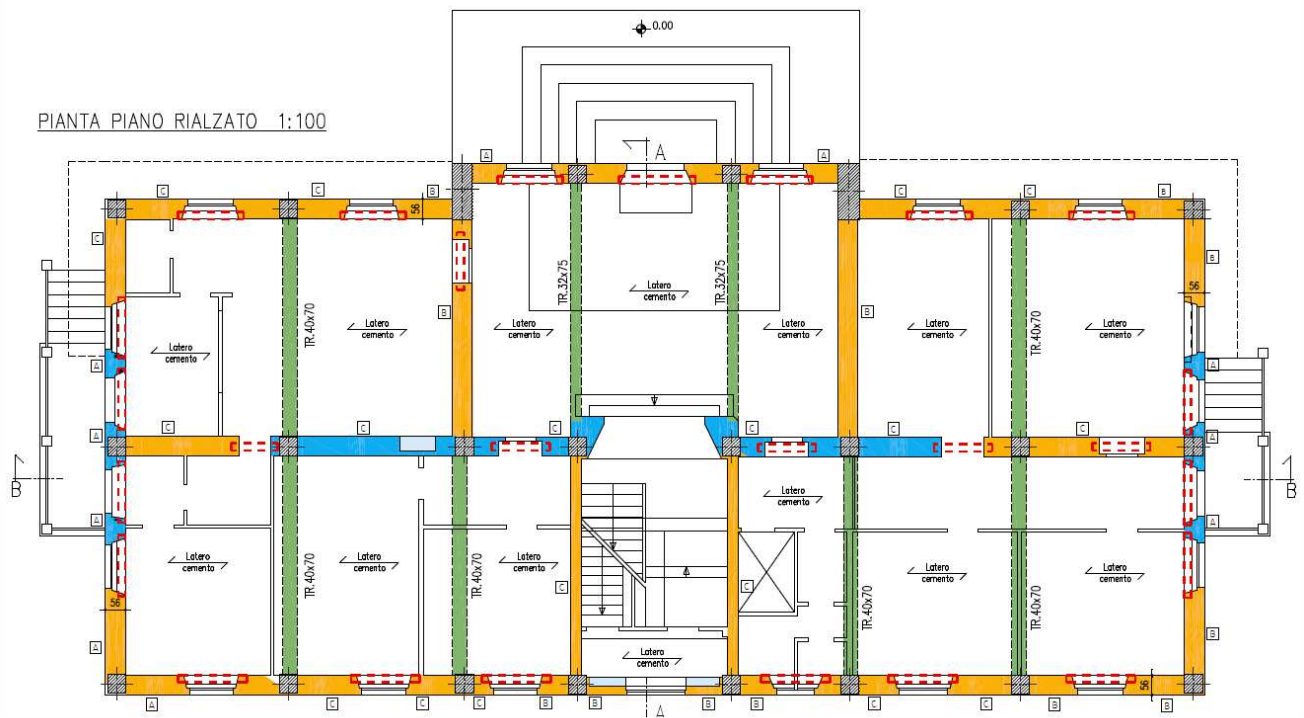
Pianta interventi Piano Rialzato e Secondo Impalcato (calpestio piano primo).
